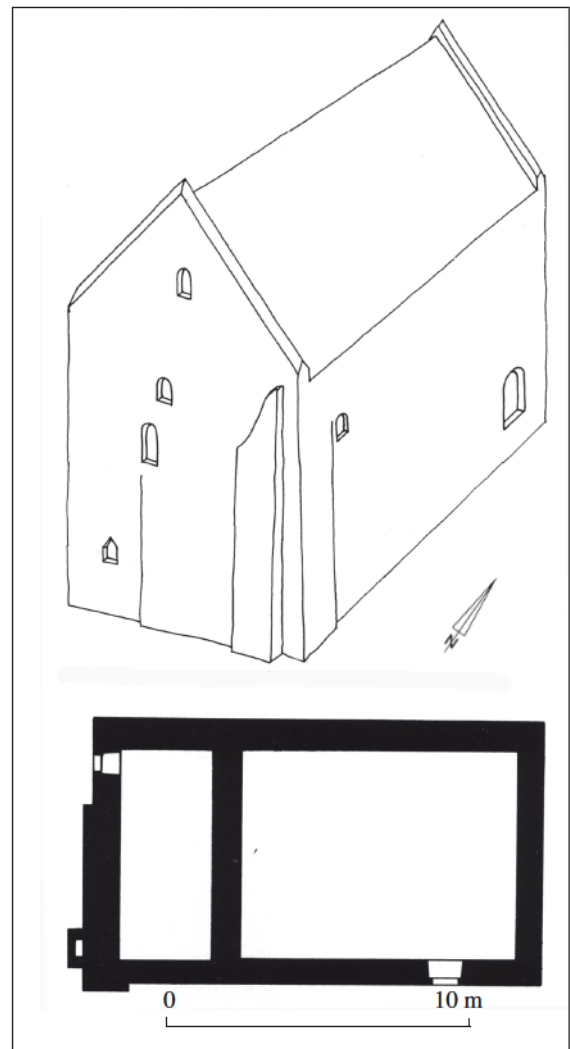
Heesenburg, Rekonstruktion des spätstaufischen Burghauses: Isometrie und Grundriss (aus: Liessem, 1977 [wie Anm. 4], S. 42).
